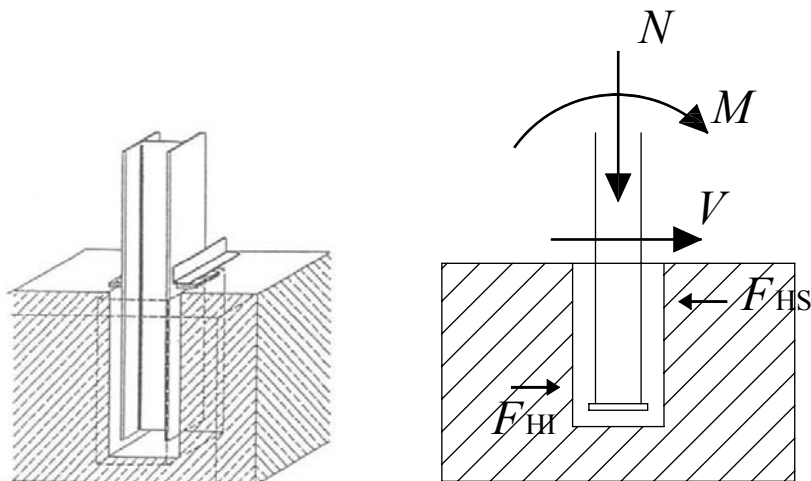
Fondation en fourreau supprimant la nécessité d'ancrages pour la reprise de M en pied de poteau.
